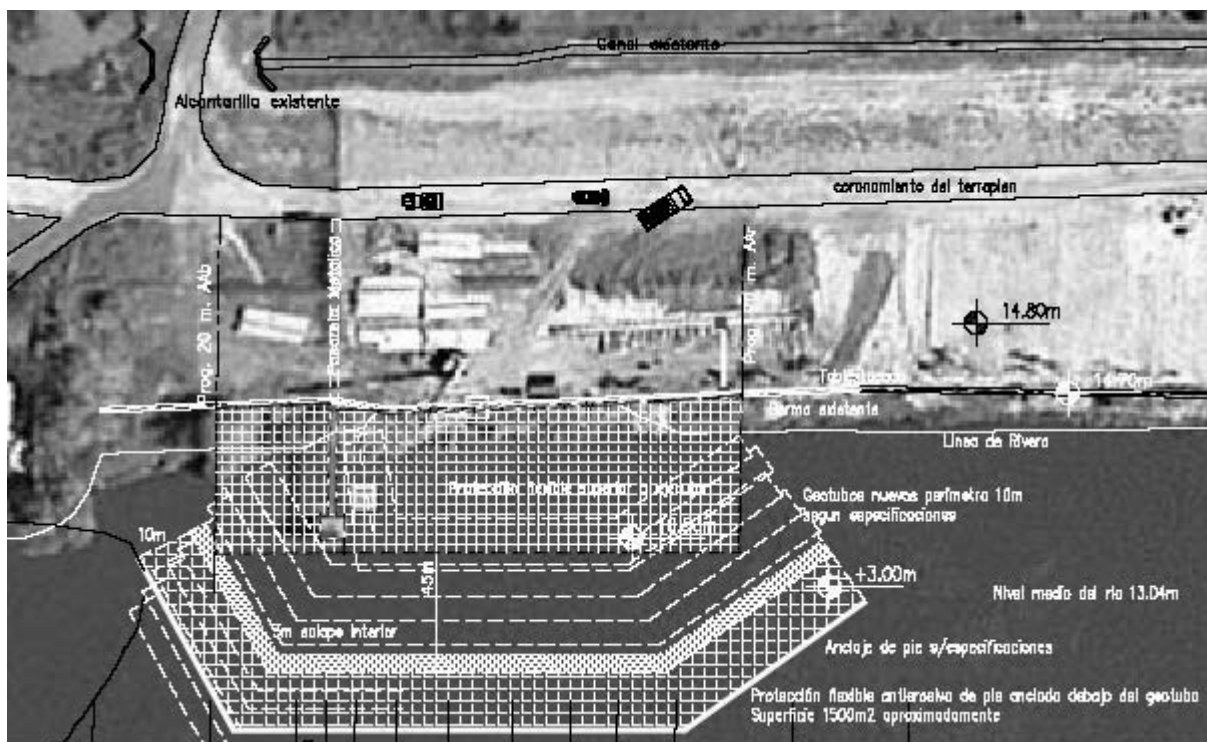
Esquema en planta de la protección antierosiva de pie y la cubierta superior
